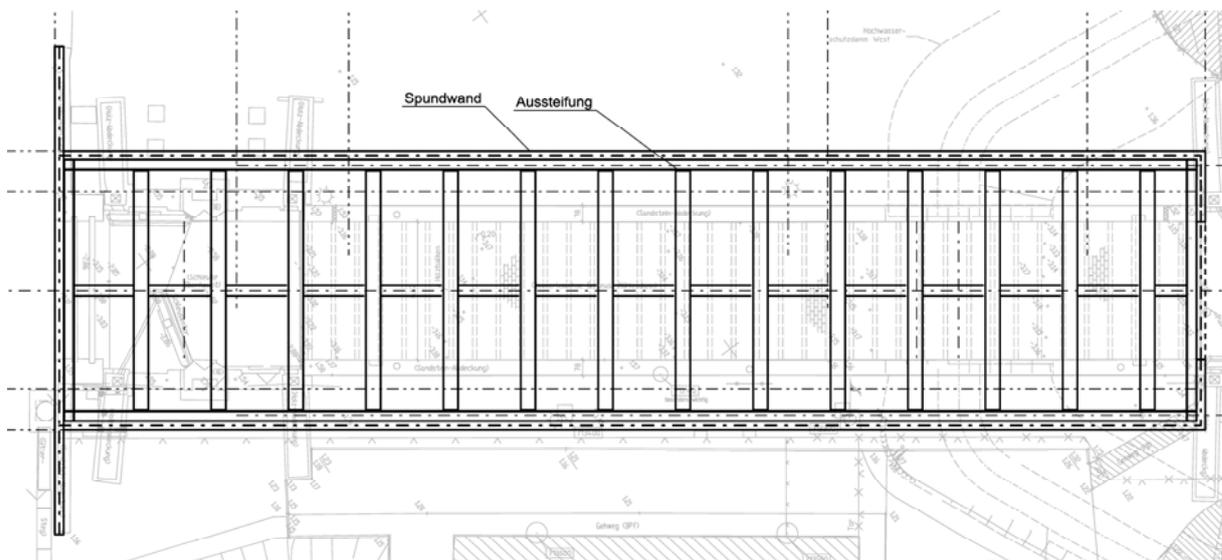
Konzept Baugrubensicherung - Draufsicht Variante 1 (Bestandssanierung mit Stahlbetontrog)
